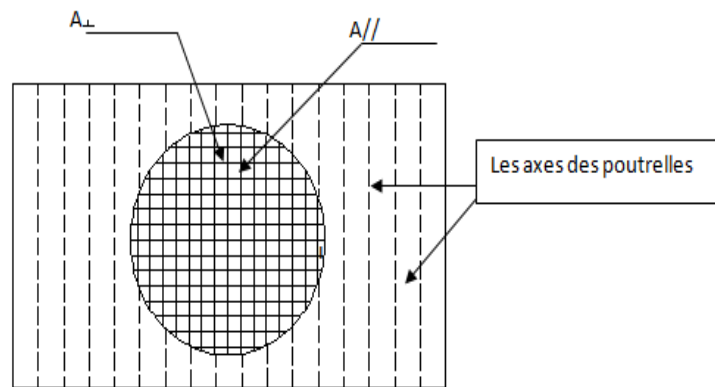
Schéma de Ferrailage de la dalle de compression.
